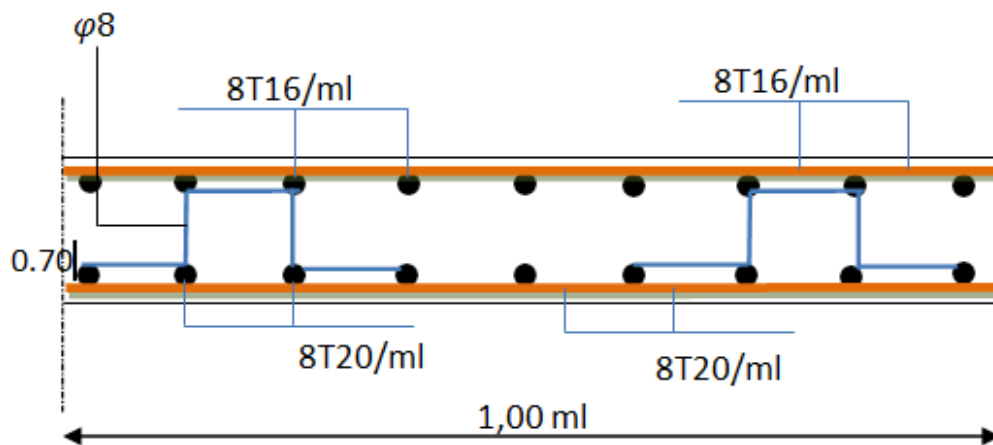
ferrailage de la dalle du radier suivant les deux sens (x,y)
